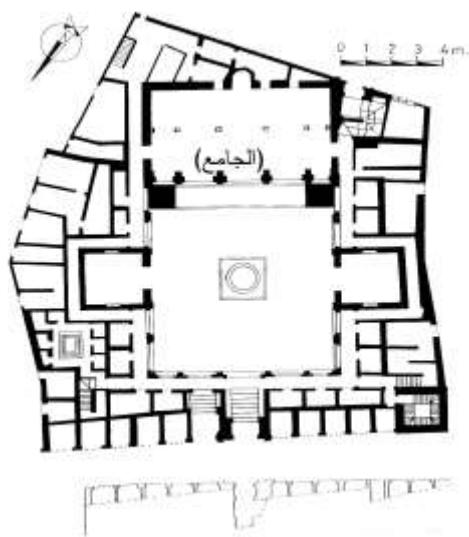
مسقط أفقى لجامع القرويين بمدينة فاس
